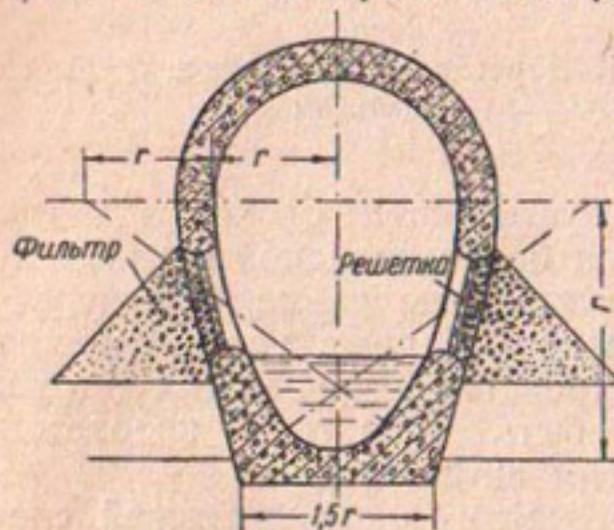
Бетонные дренажные трубы с плоским основанием
